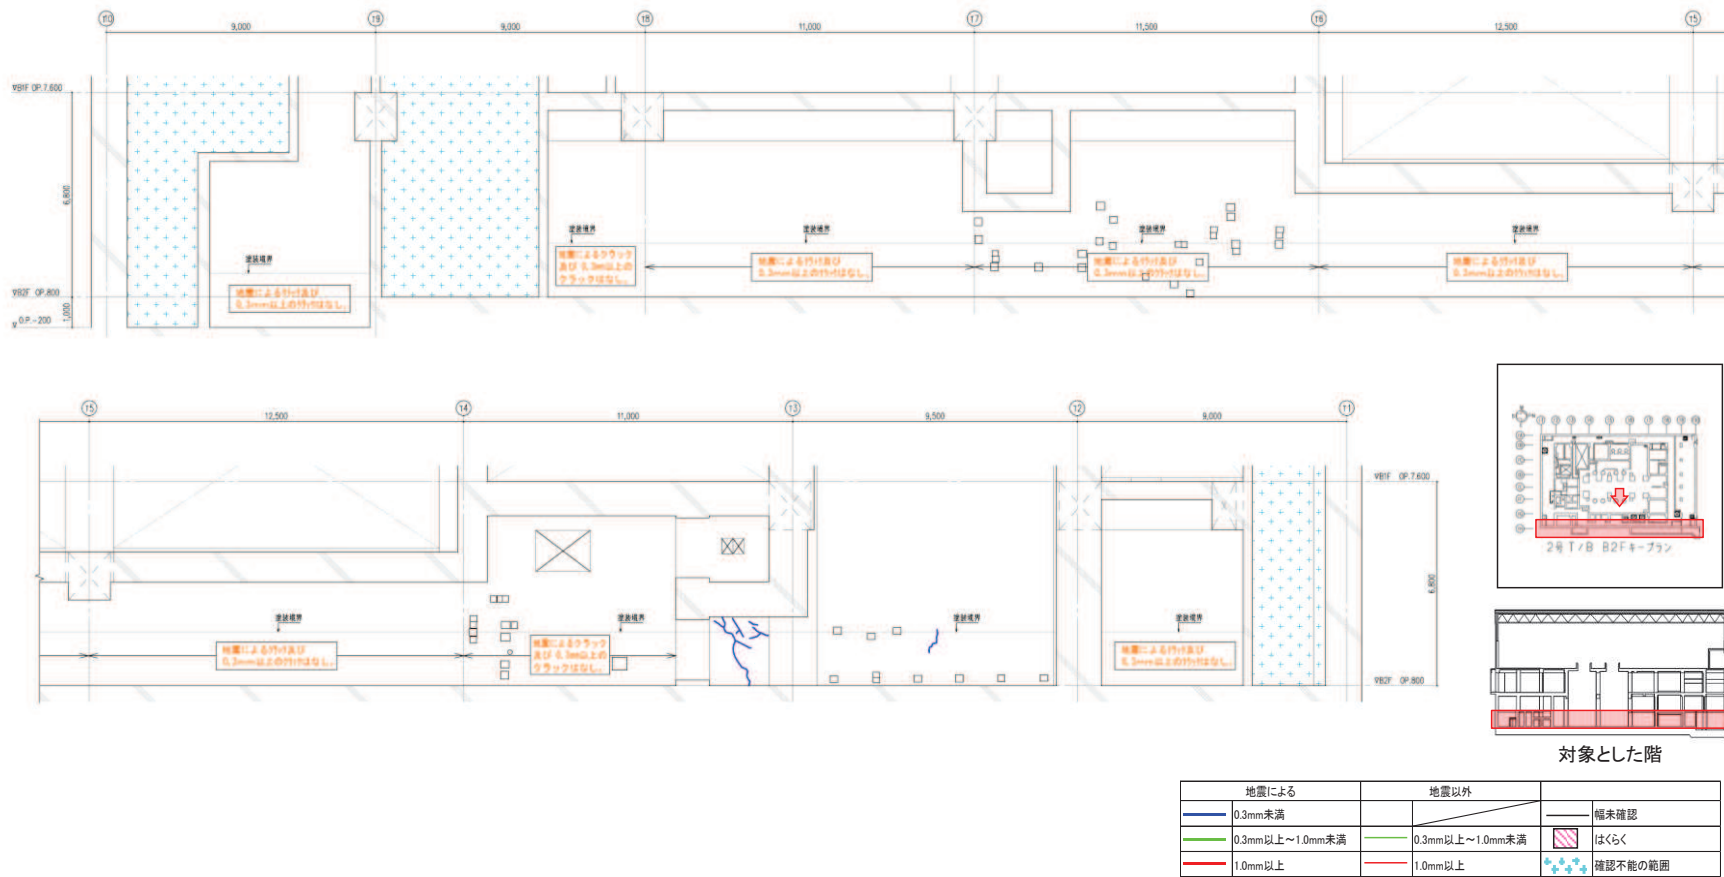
タービン建屋のひび割れ分布 耐震壁 (16) 地下 2 階 TH 通り
